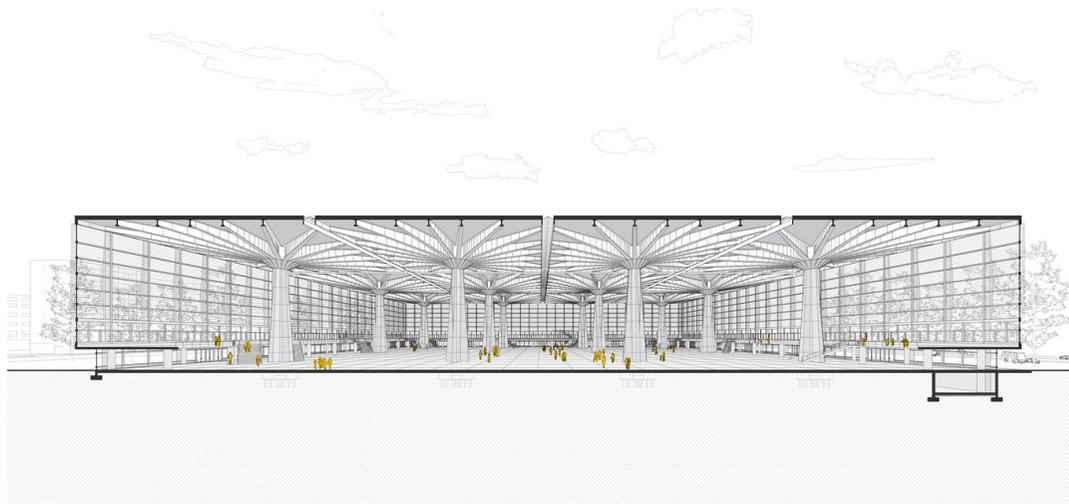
Extrusión / Palace of Labor, Pier Luigi Nervi, 1961.
